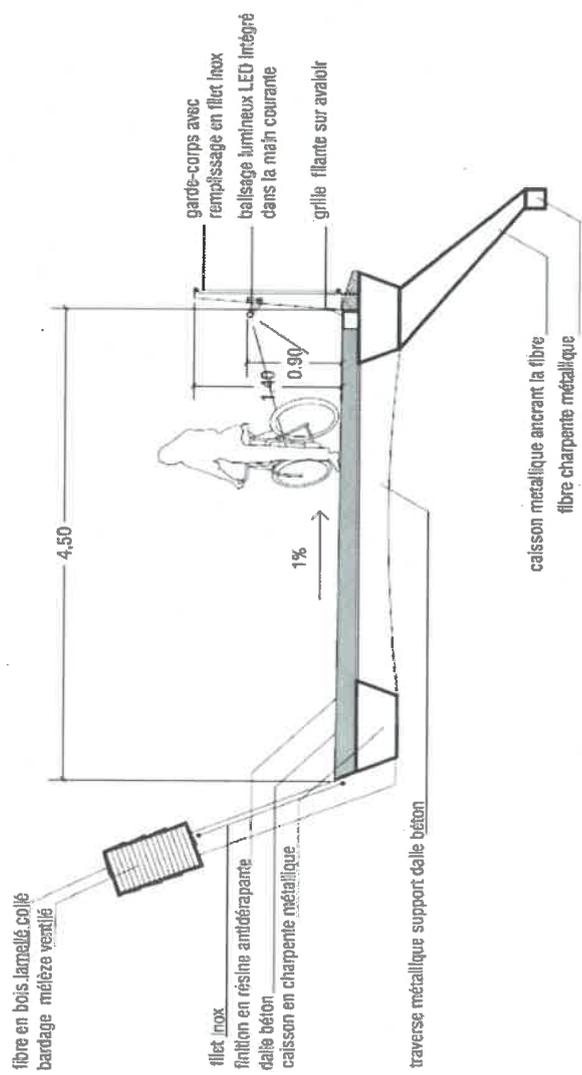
Coupe transversale type de la passerelle – Source : Cabinet d'architecture Marc MIMRAM
